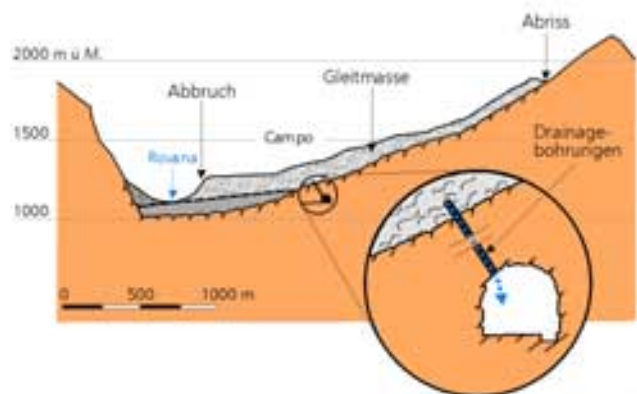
Rutschung von Campo Vallemaggia, schematischer Längsschnitt mit Detail des Drainagesystems (nach LOMBARDI 1996).
